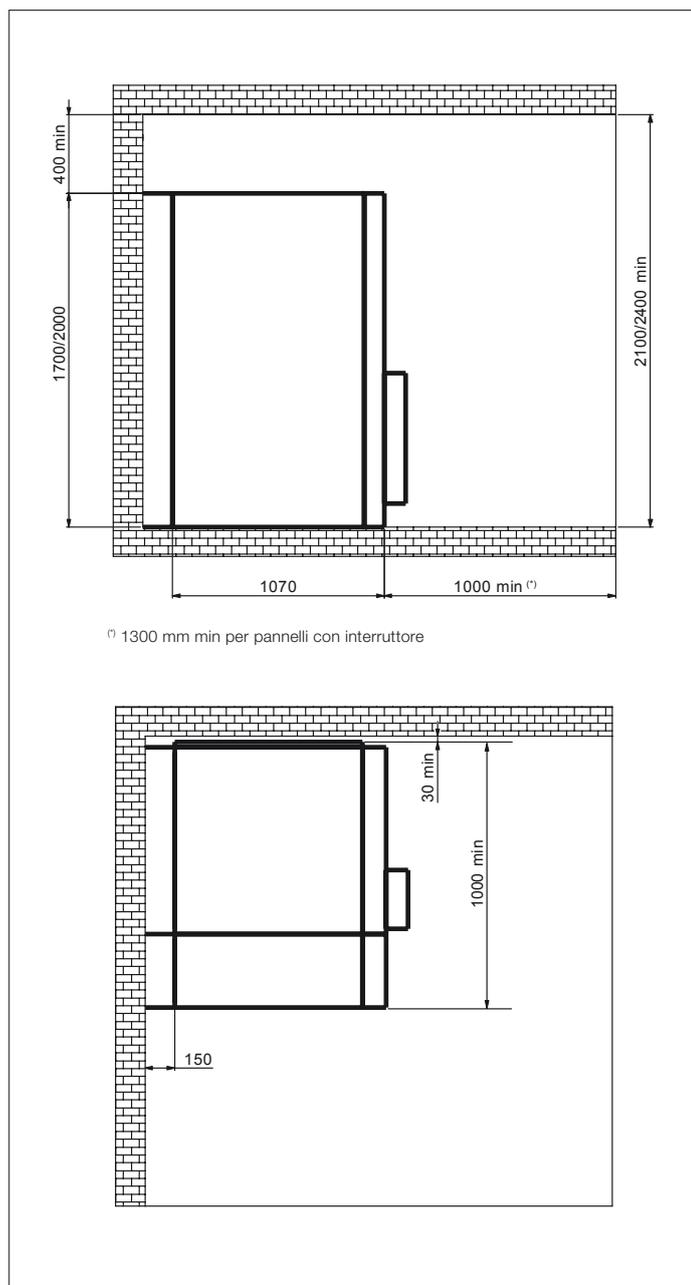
Distanze rispetto alle pareti del locale di installazione con vano sfogo dei gas sul retro, soluzione IAC A-FL 12,5 kA 1s addossata a parete
